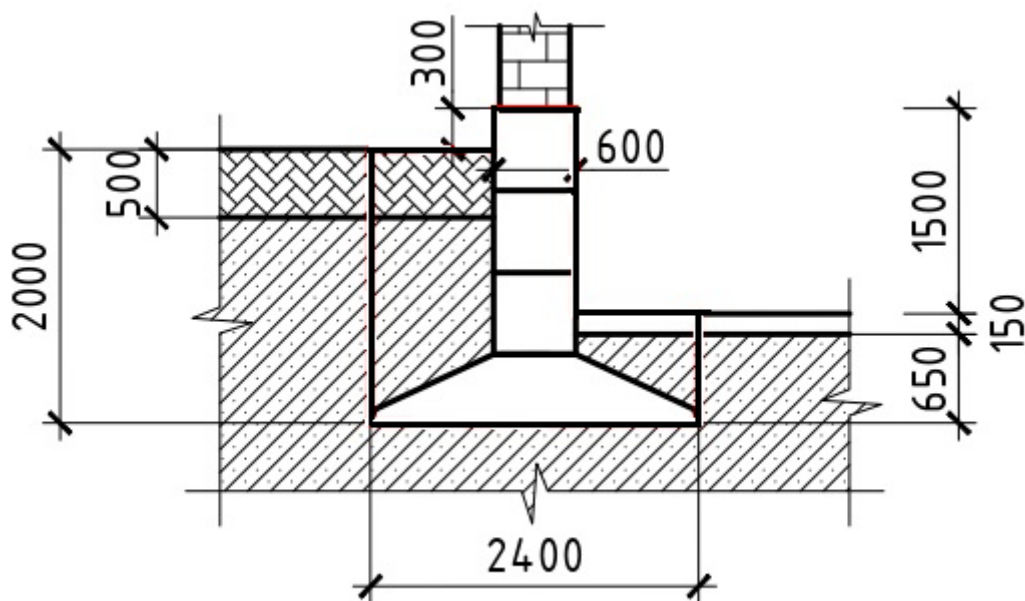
Схема фундаментної опори під зовнішню стіну
